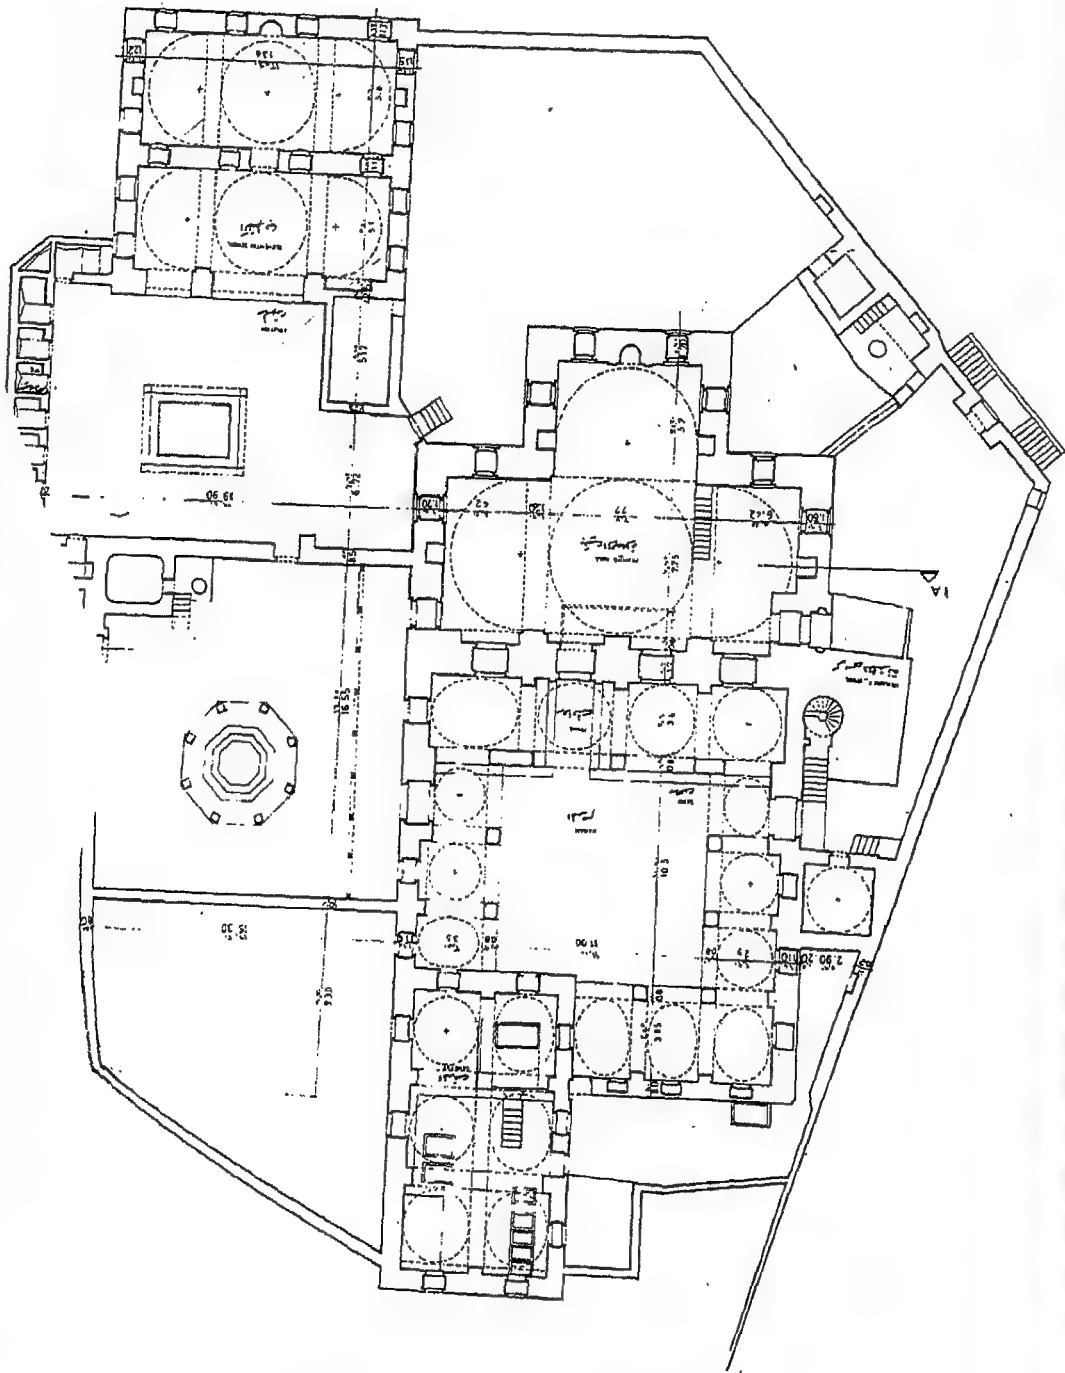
مسقط أفقي لجامع بباله باشا بقاسم باشا في إستانبول. (كران)
